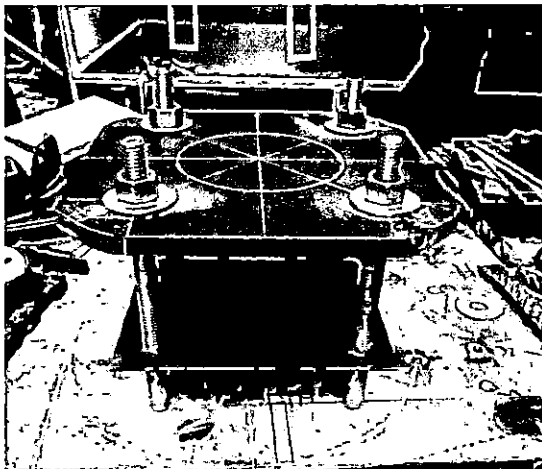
Simulación de armado de plancha de Fijación en Taller
